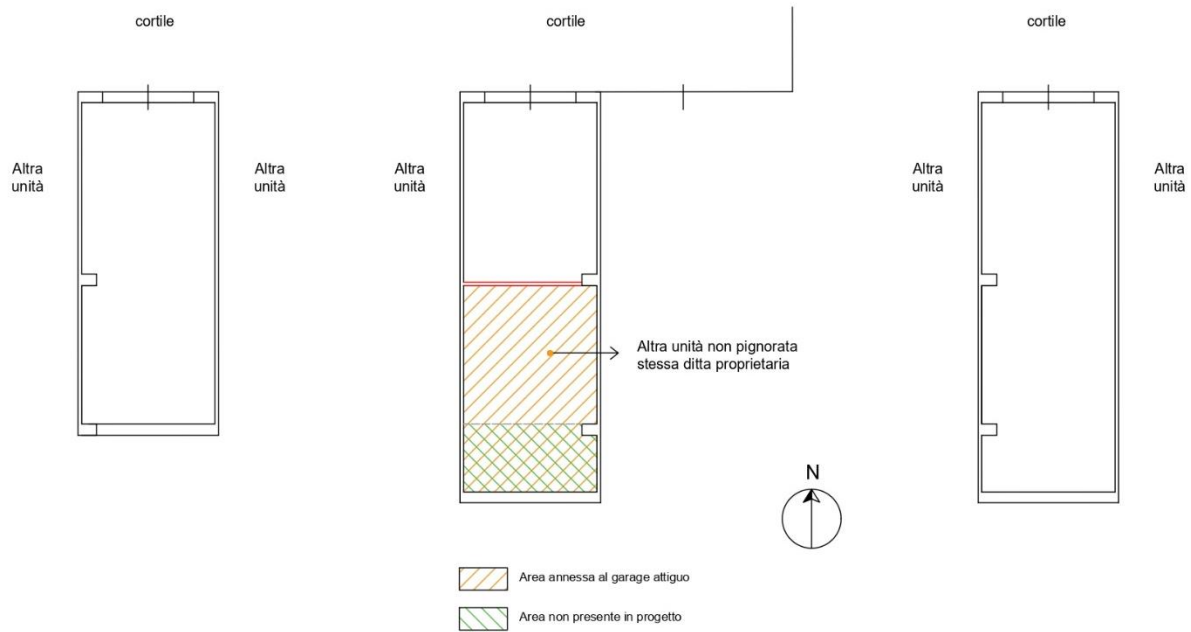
\_Garage – Raffronto tra elaborato grafico di progetto, rilievo stato attuale dei luoghi e planimetria catastale.
